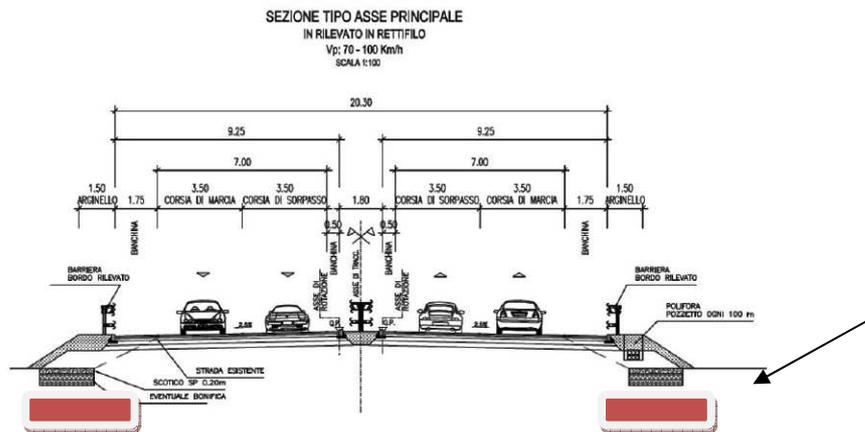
Sezione tipo asse principale in rilevato rettilineo (in rosso aree interessate dai saggi)
